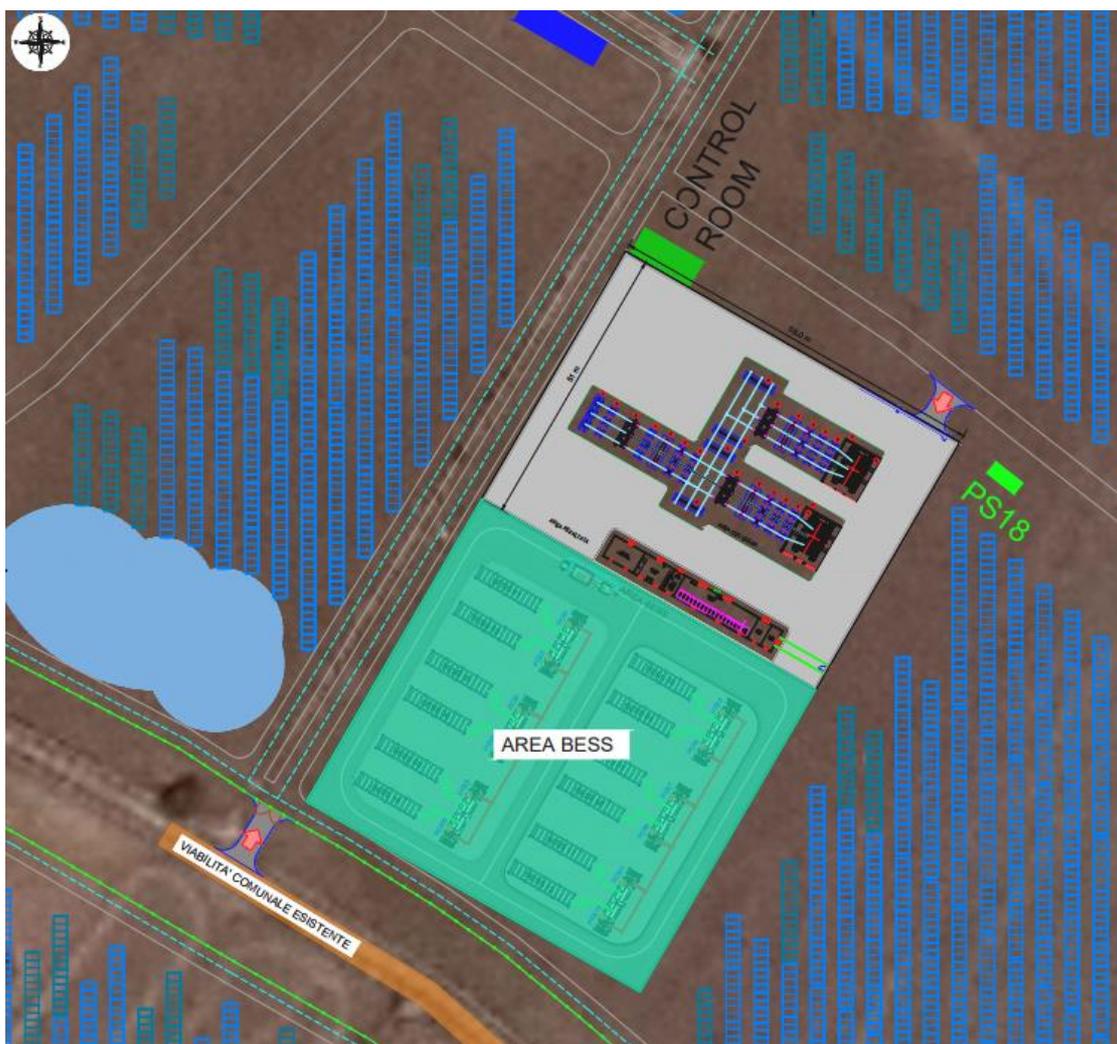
Planimetria su ortofoto con individuazione nuova SSE
